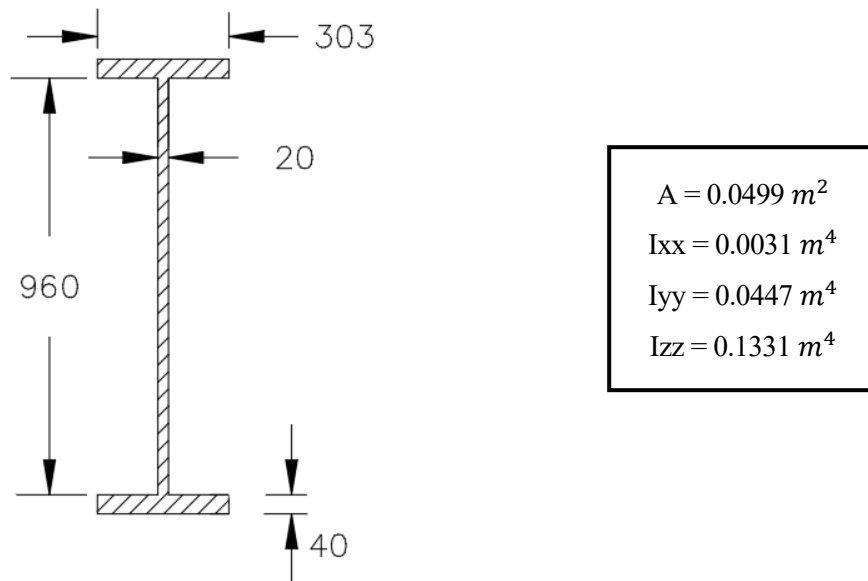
Geometría y propiedades mecánicas vigas transversales en I
